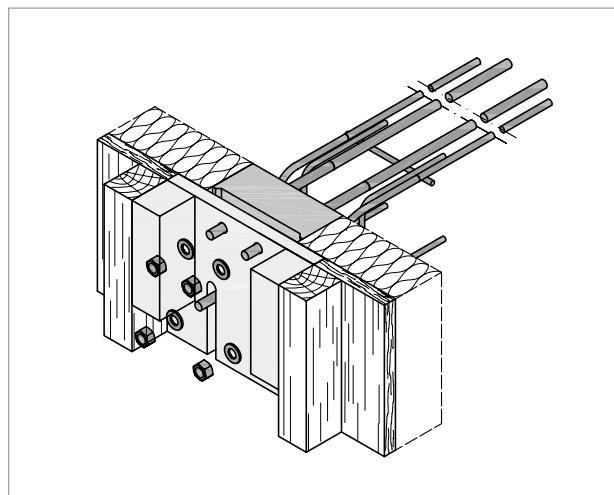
Schöck Isokorb® T type SK : aide au montage inversée pour permettre une isolation parfaite des bords de la dalle en cas de mur monolithique
